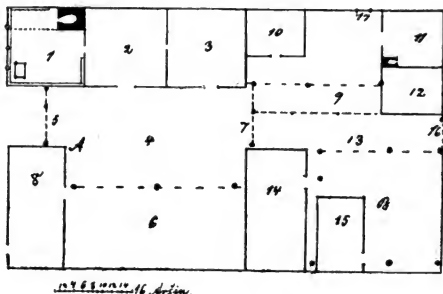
Grundriss eines russischen Hauses. Jerahtur. Rāzan.
